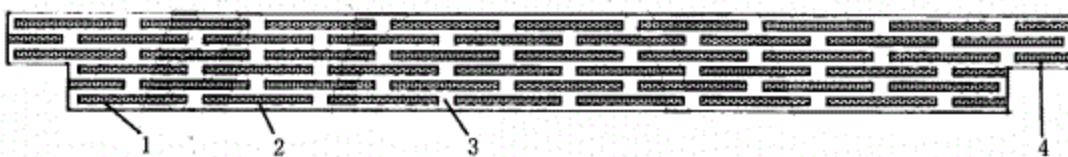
密肋式自保温混凝土夹芯墙板标准板构造示意图
